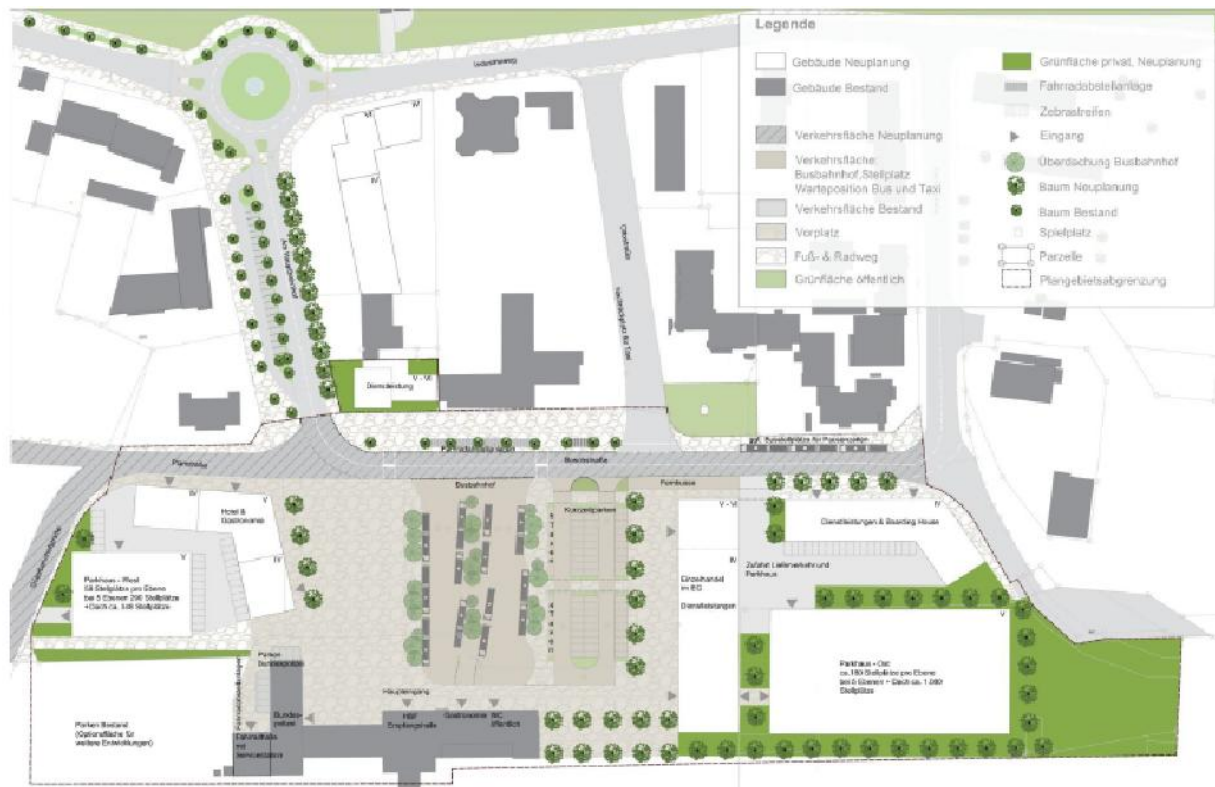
Städtebaulicher Rahmenplan (Quelle: 2017 StadtLandBahn)
